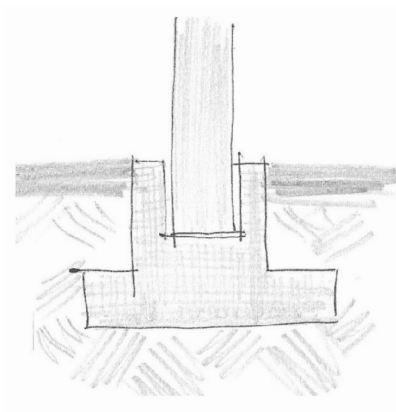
Particolare della fondazione tipica con plinto a bicchiere al piede della colonna
